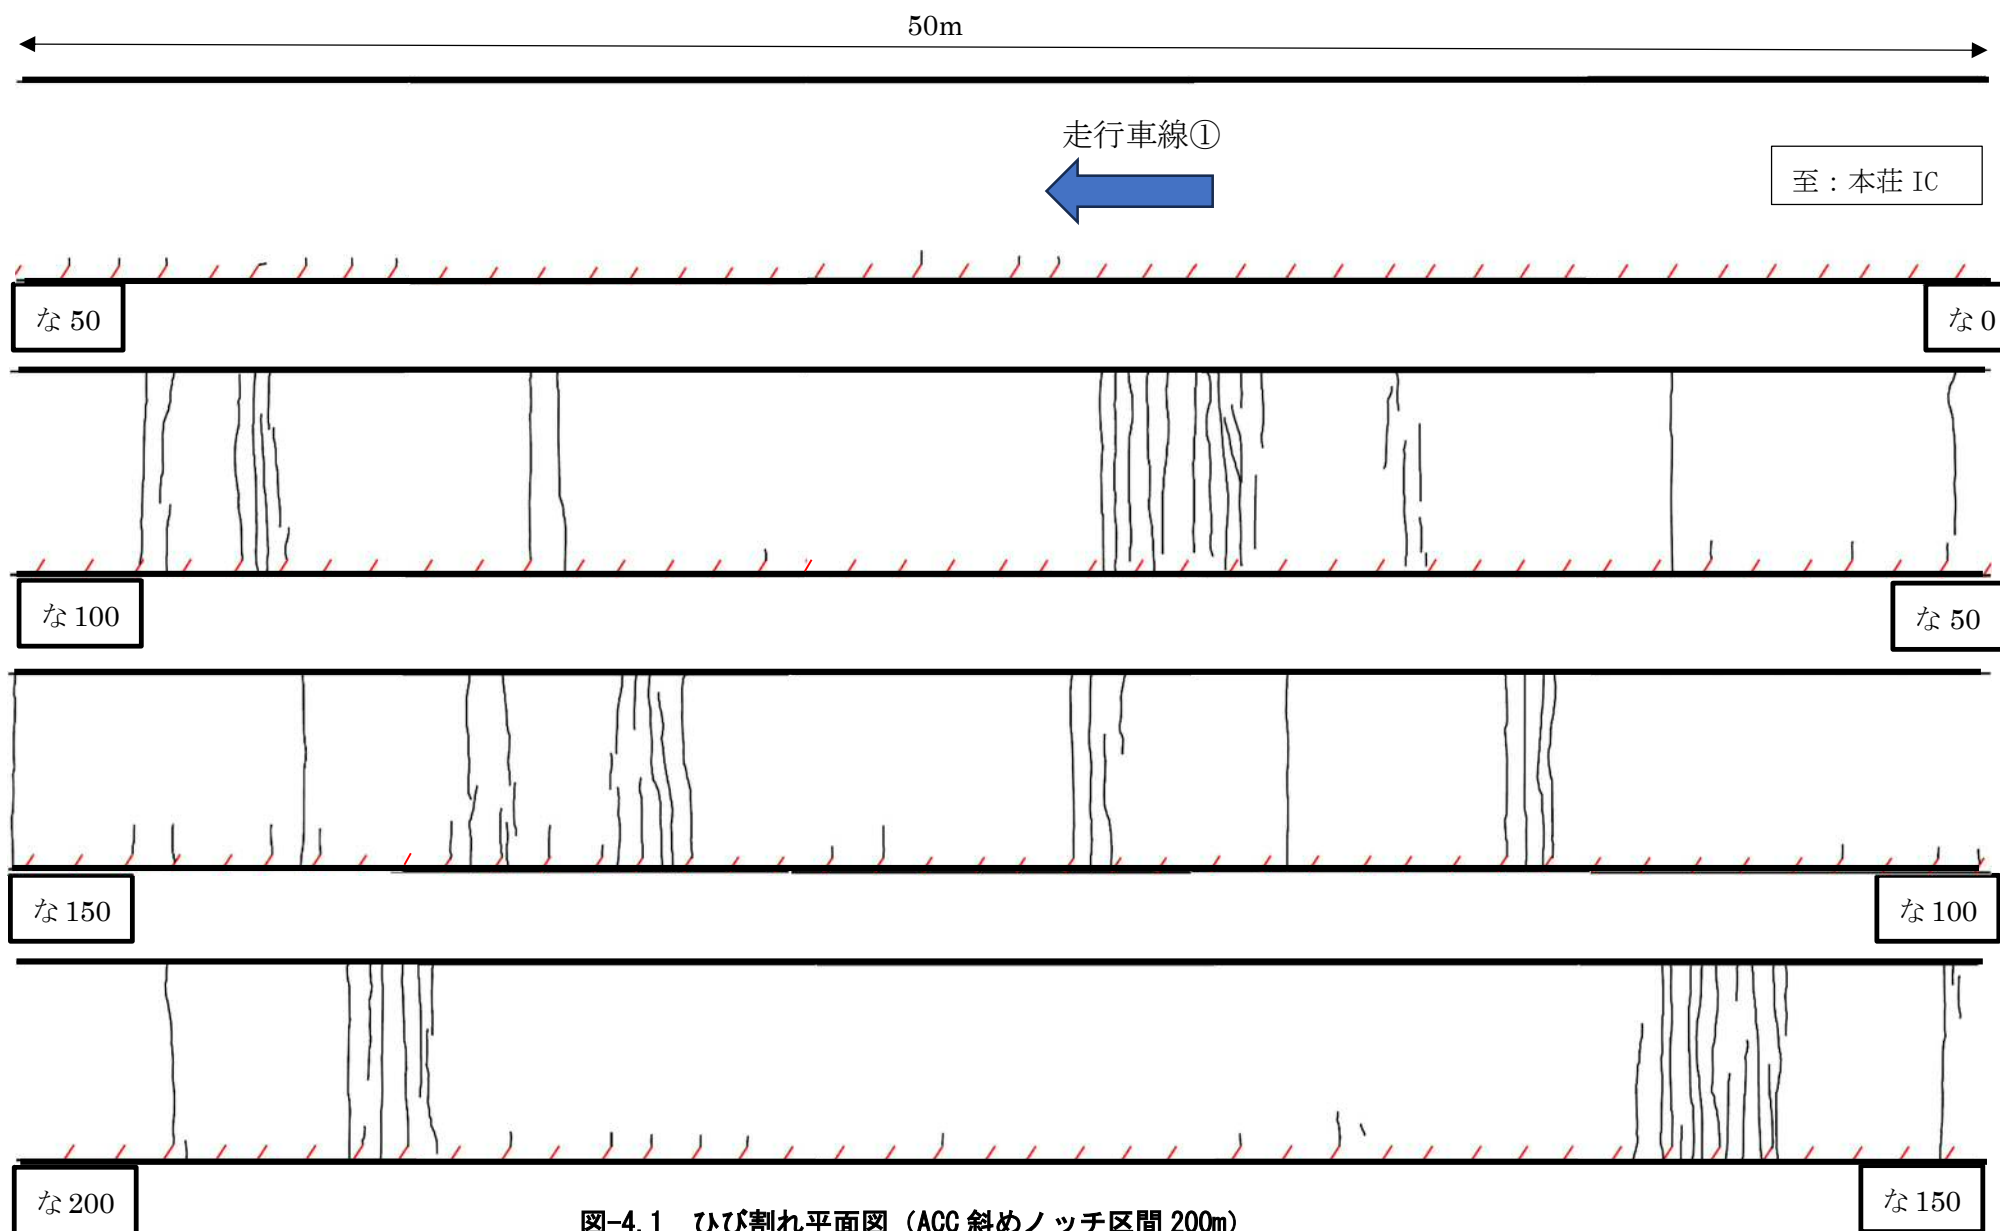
ひび割れ平面図 (ACC 斜めノッチ区間 200m)
